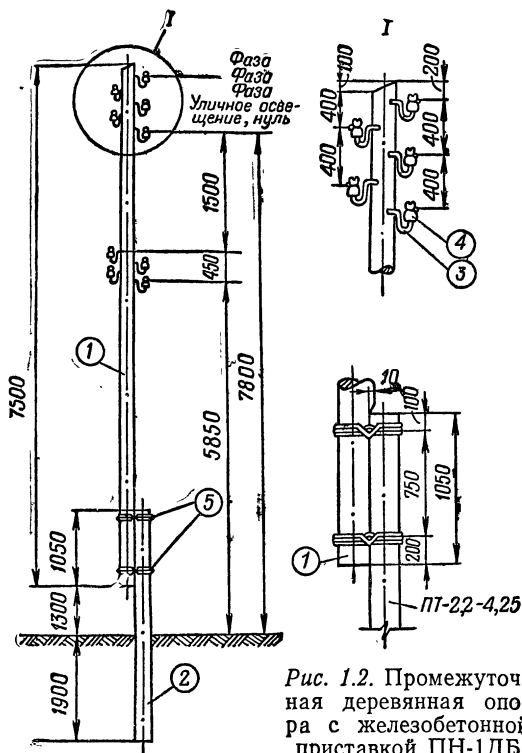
Промежуточная деревянная опора с железобетонной приставкой ПН-1ДБ
